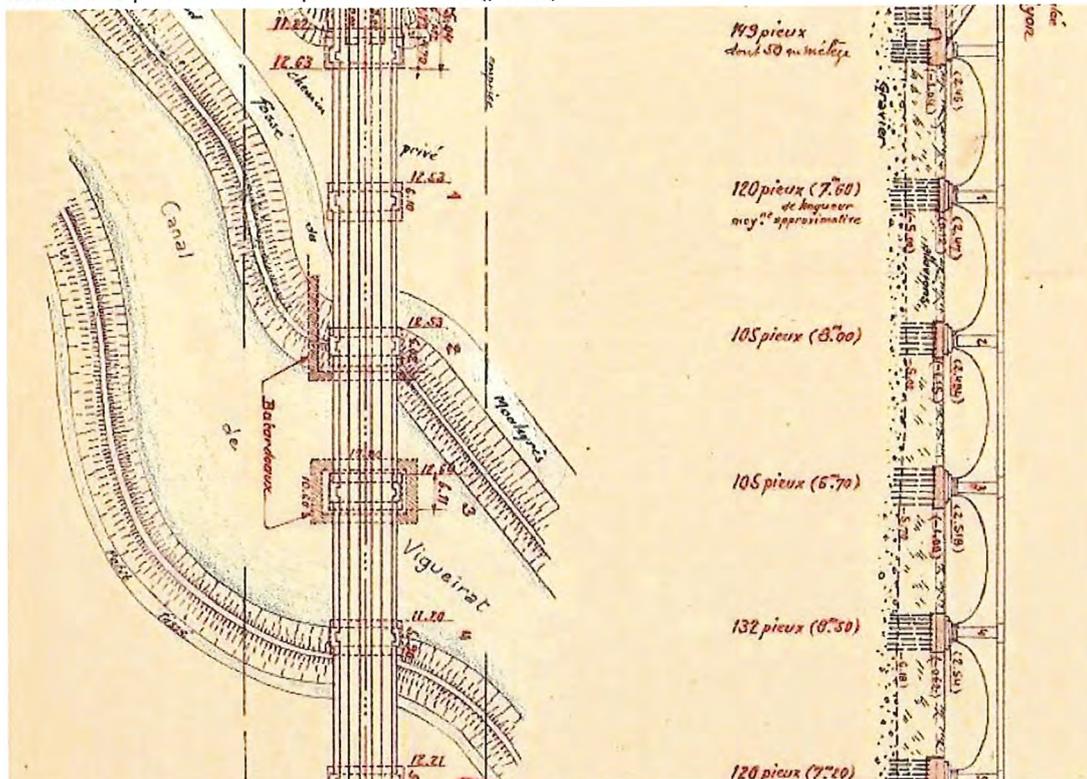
plans du viaduc au niveau de la traversée du Vigueirat
